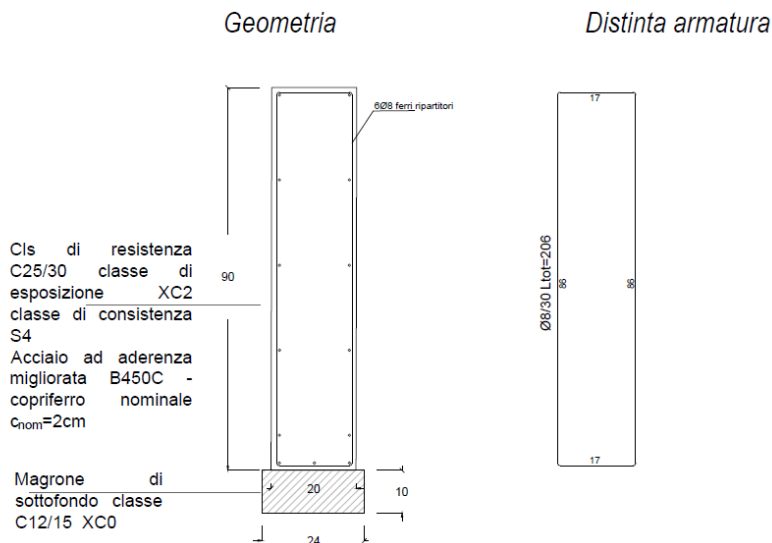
Tipologia n.01 – muretto di recinzione in c.a.
